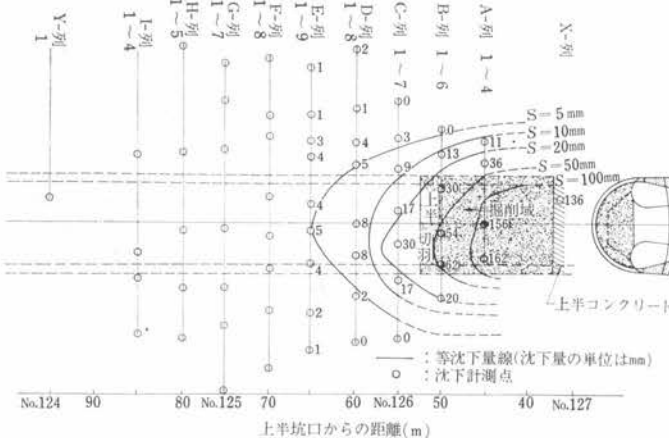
5月25日の上半施工状況と地表面の沈下状況(平面図)
